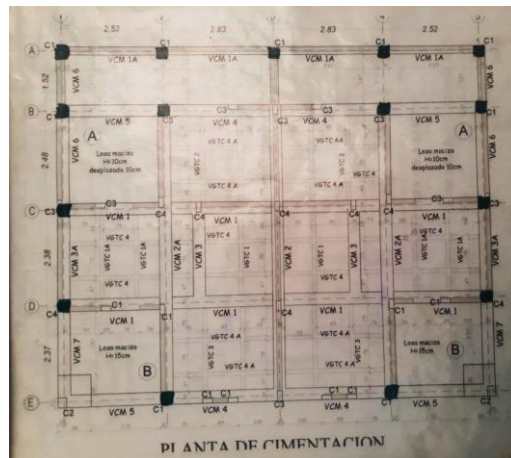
Plano estructural planta de cimentación. Fuente: autor.
